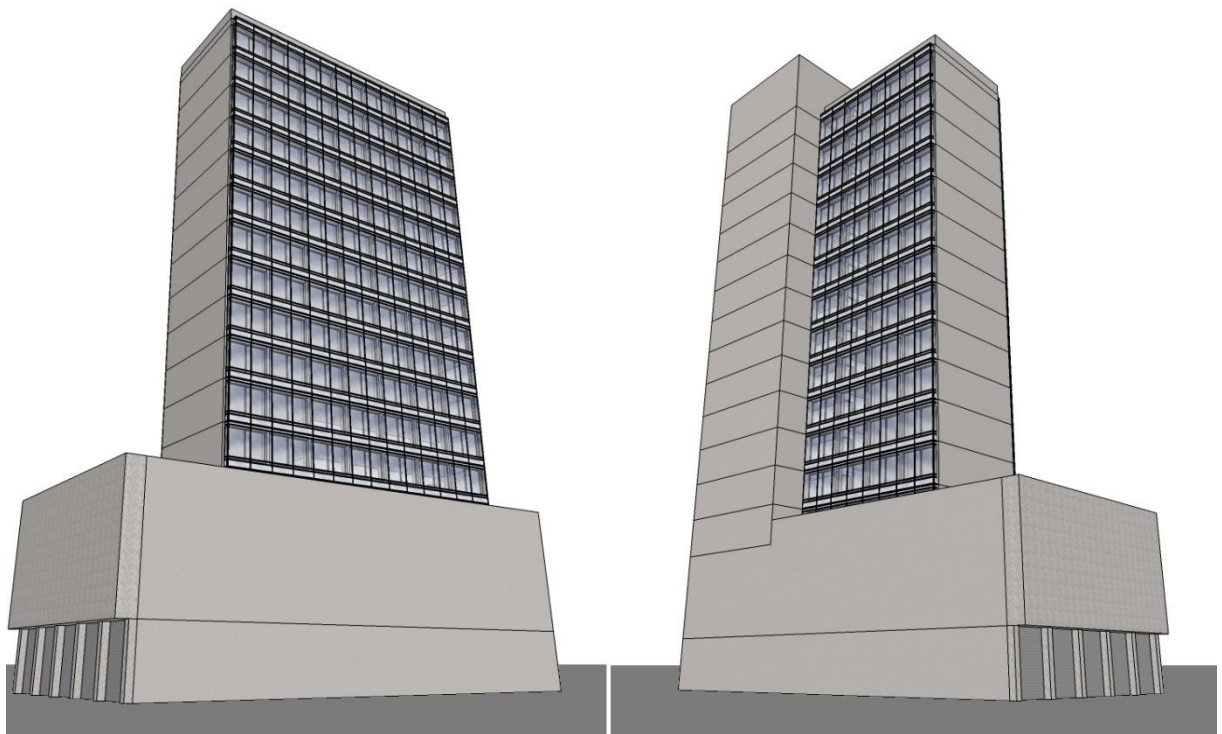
Vistas do observador da fachada nordeste e sudoeste.
